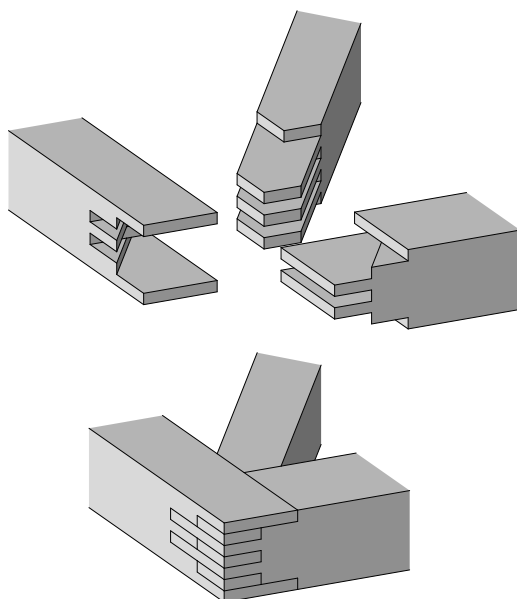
Pianta strutturale e dettaglio dell'incastro delle travi di bordo
